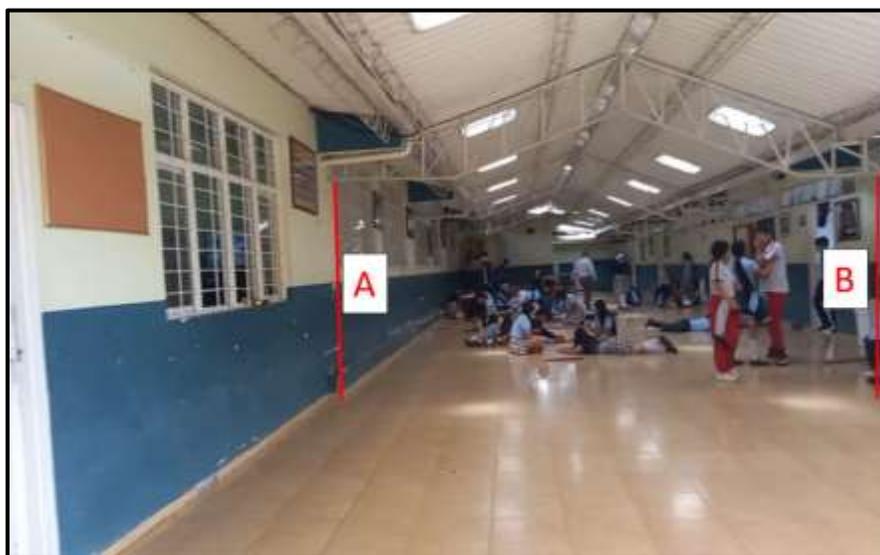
Cercha soporte lateral y grietas de tipo estructural
